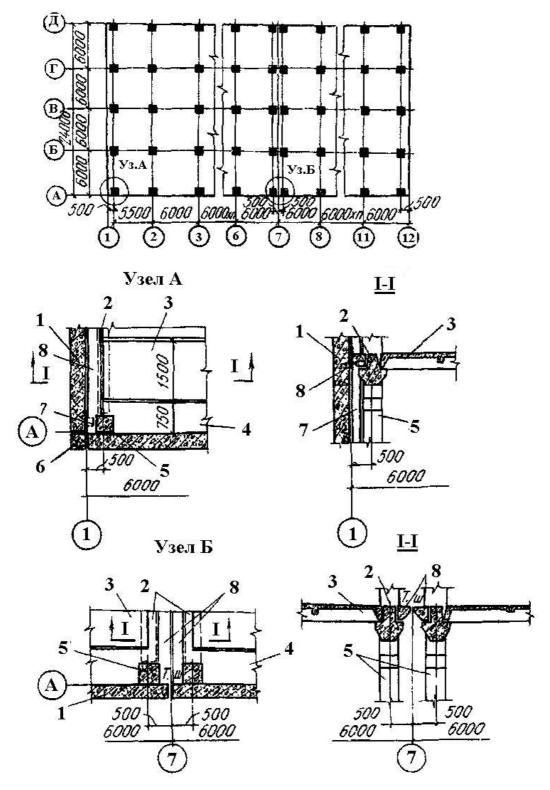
План многоэтажного промышленного здания с узлами привязки колонн и стен к разбивочным осям (Узел А – привязка угловой колонны и стен к разбивочным осям; Узел Б – привязка колонн к разбивочным осям в деформационных швах многоэтажных зданий): 1 – стеновая панель; 2 – ригель (балка); 3 – плита перекрытия; 4 – доборная плита перекрытия; 5 –колонна; 6 – угловой блок; 7 – стойка фахверка; 8 – монолитный железобетон
